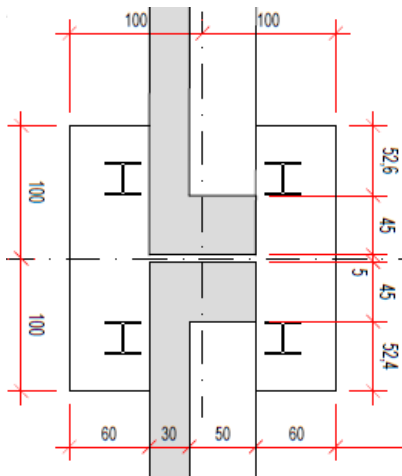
DETALHES JUNTAS DE EXPANSÃO
